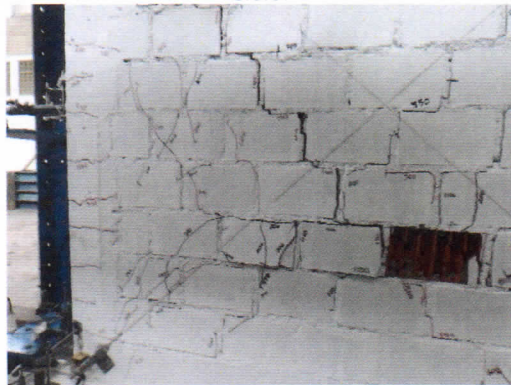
Agrietamiento pequeño correspondiente a la continuación de grietas diagonales en el lado Este de la cara Norte y Levantamiento de dos ladrillos en la zona central para una distorsión de 1/200 en el 1° ciclo.
